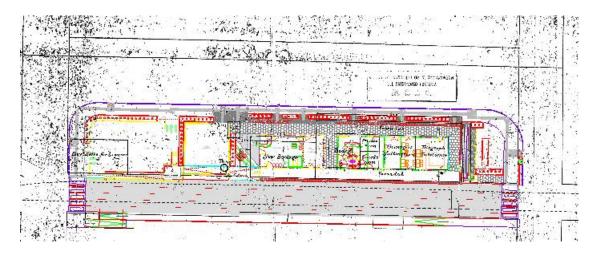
Traslape de plano antiguo y plano actual en color, donde se muestra la sección de bahareque como la primera etapa de construcción. (Crédito: M.B. Esquivel, 2019)
